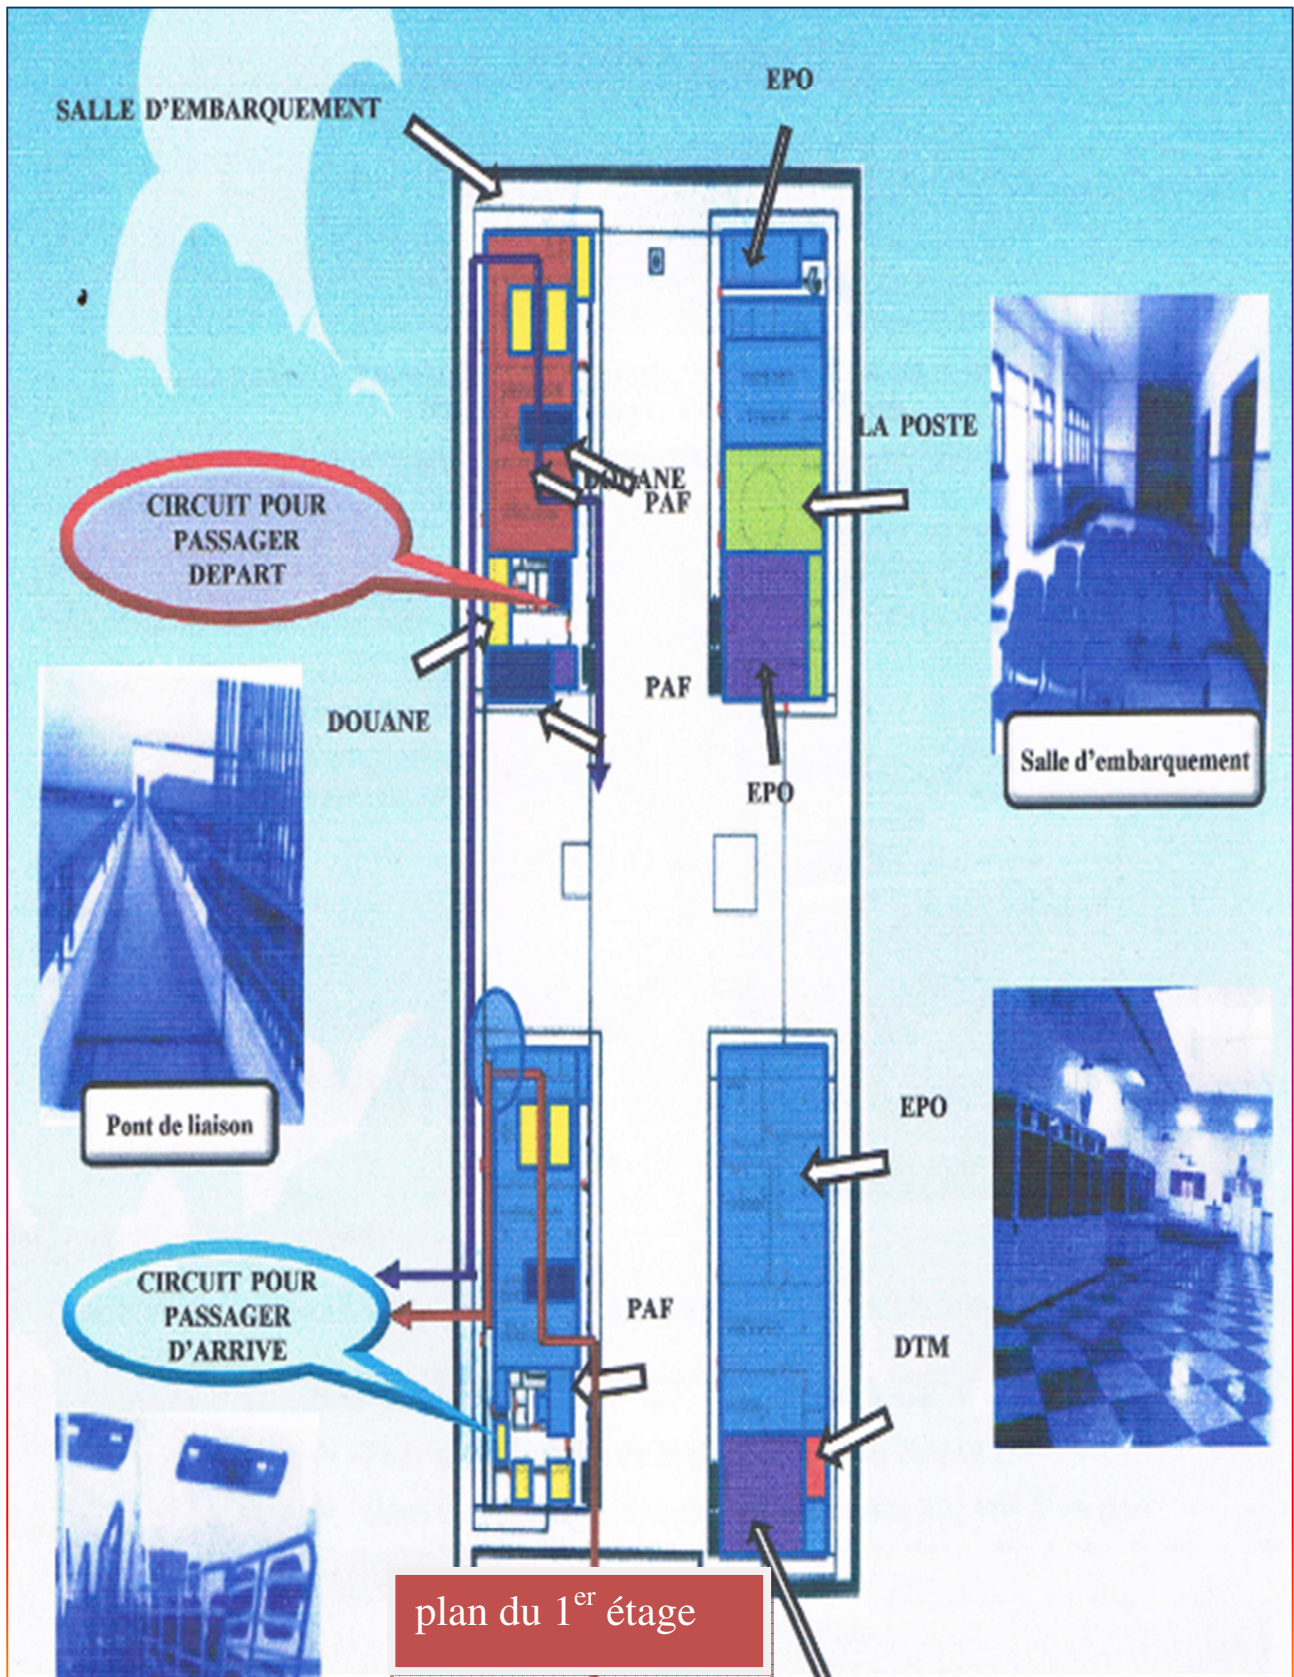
photo et plans du projet , source :web modifiée par l'auteur du mémoire
